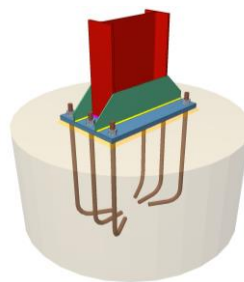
Placa de anclaje de los pilares de los pórticos interiores
